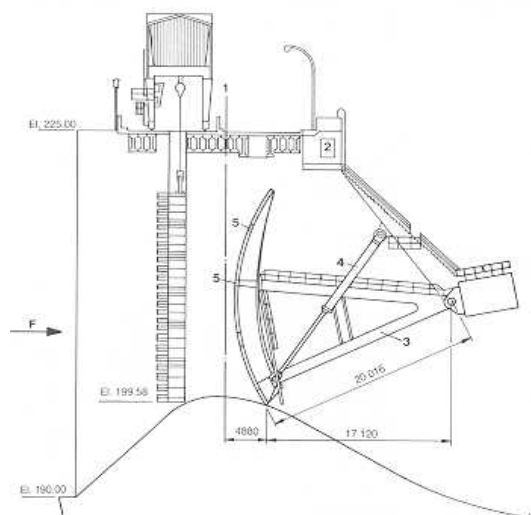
Compuerta del Vertedero – Vista Lateral
